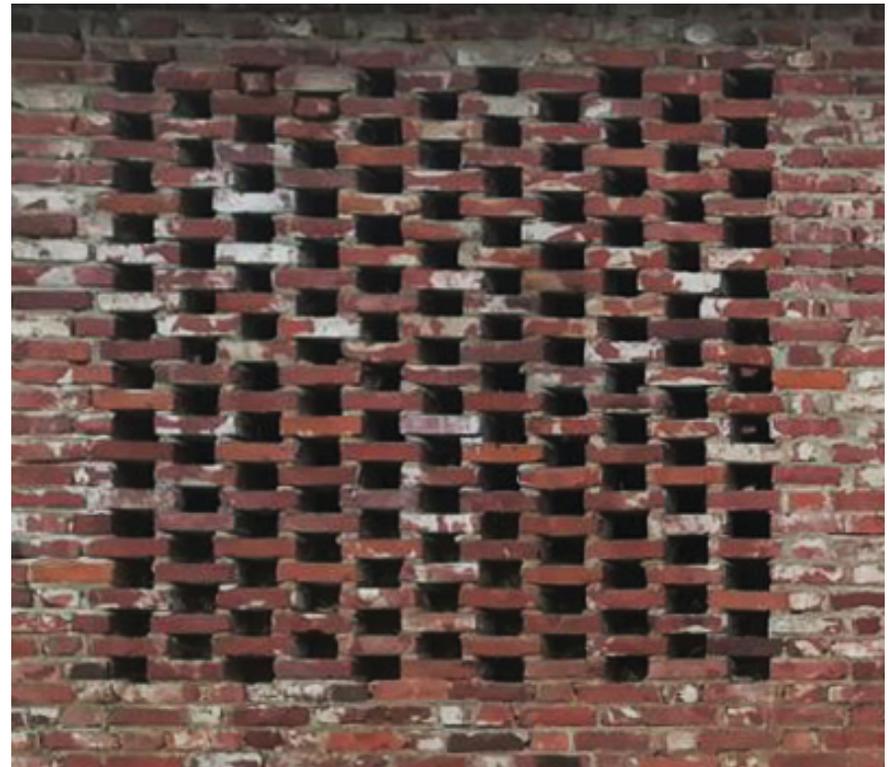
Lüftungsöffnungen im traditionellen Stall für Strohlagerung
